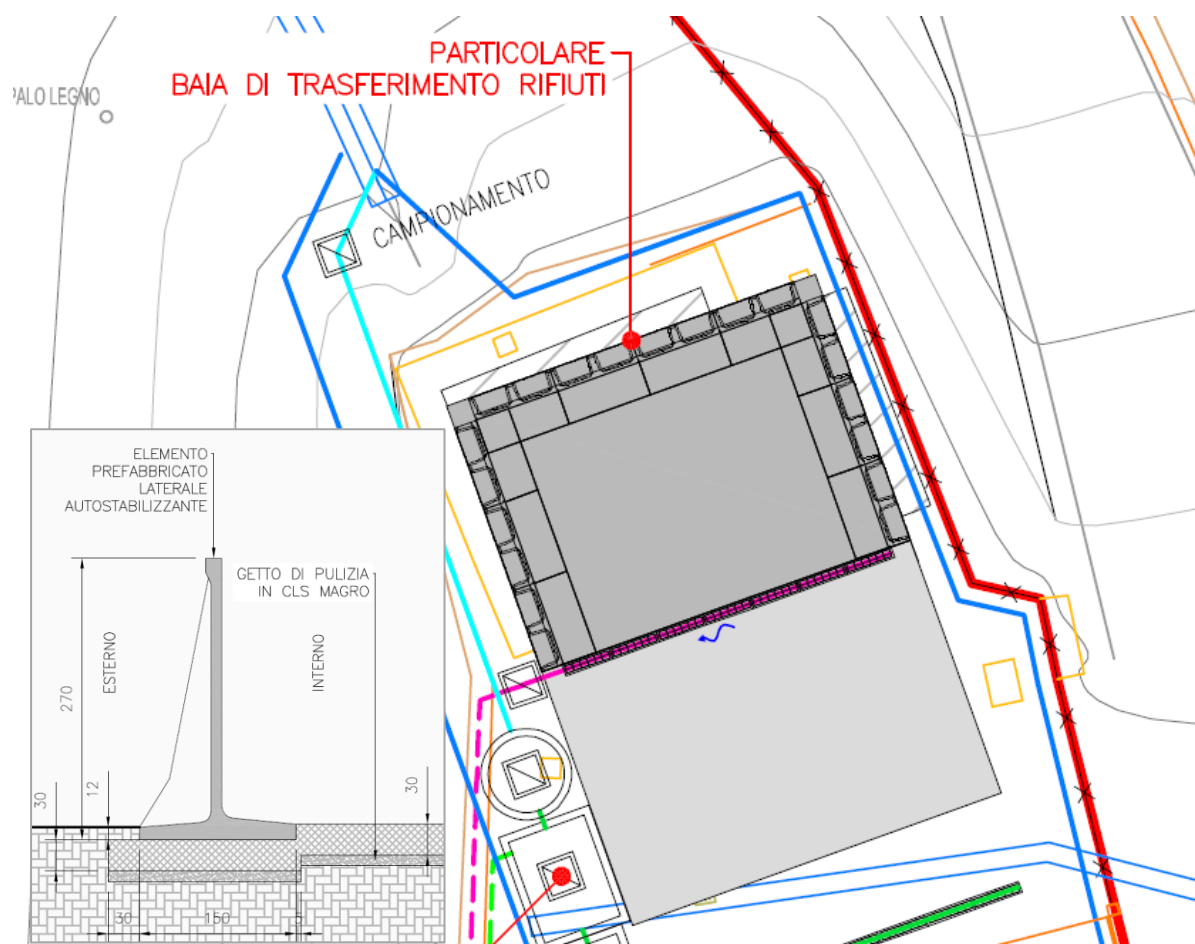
Baia di trasferimento rifiuti e particolare muro portante perimetrale in moduli prefabbricati
